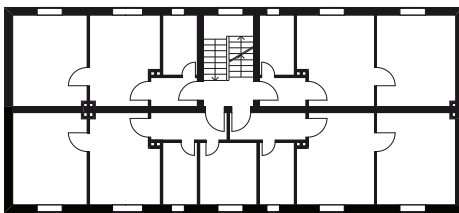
Grundriss der Schlichtwohnungen im 1. Bauabschnitt als 4-Spänner mit einseitig belichteten und belüfteten Wohnungen sowie gefangenen Räumen
